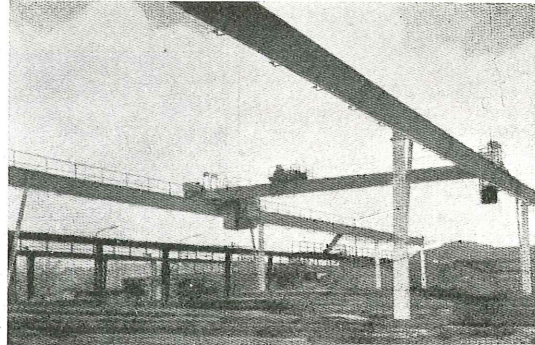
Vigas carril para puente grúa en Dresden. Son vigas de sección en cajón triangular, de 1 m de canto y 24 m de luz, para puente de 5 t. Pesar 208 Kg/m l.
